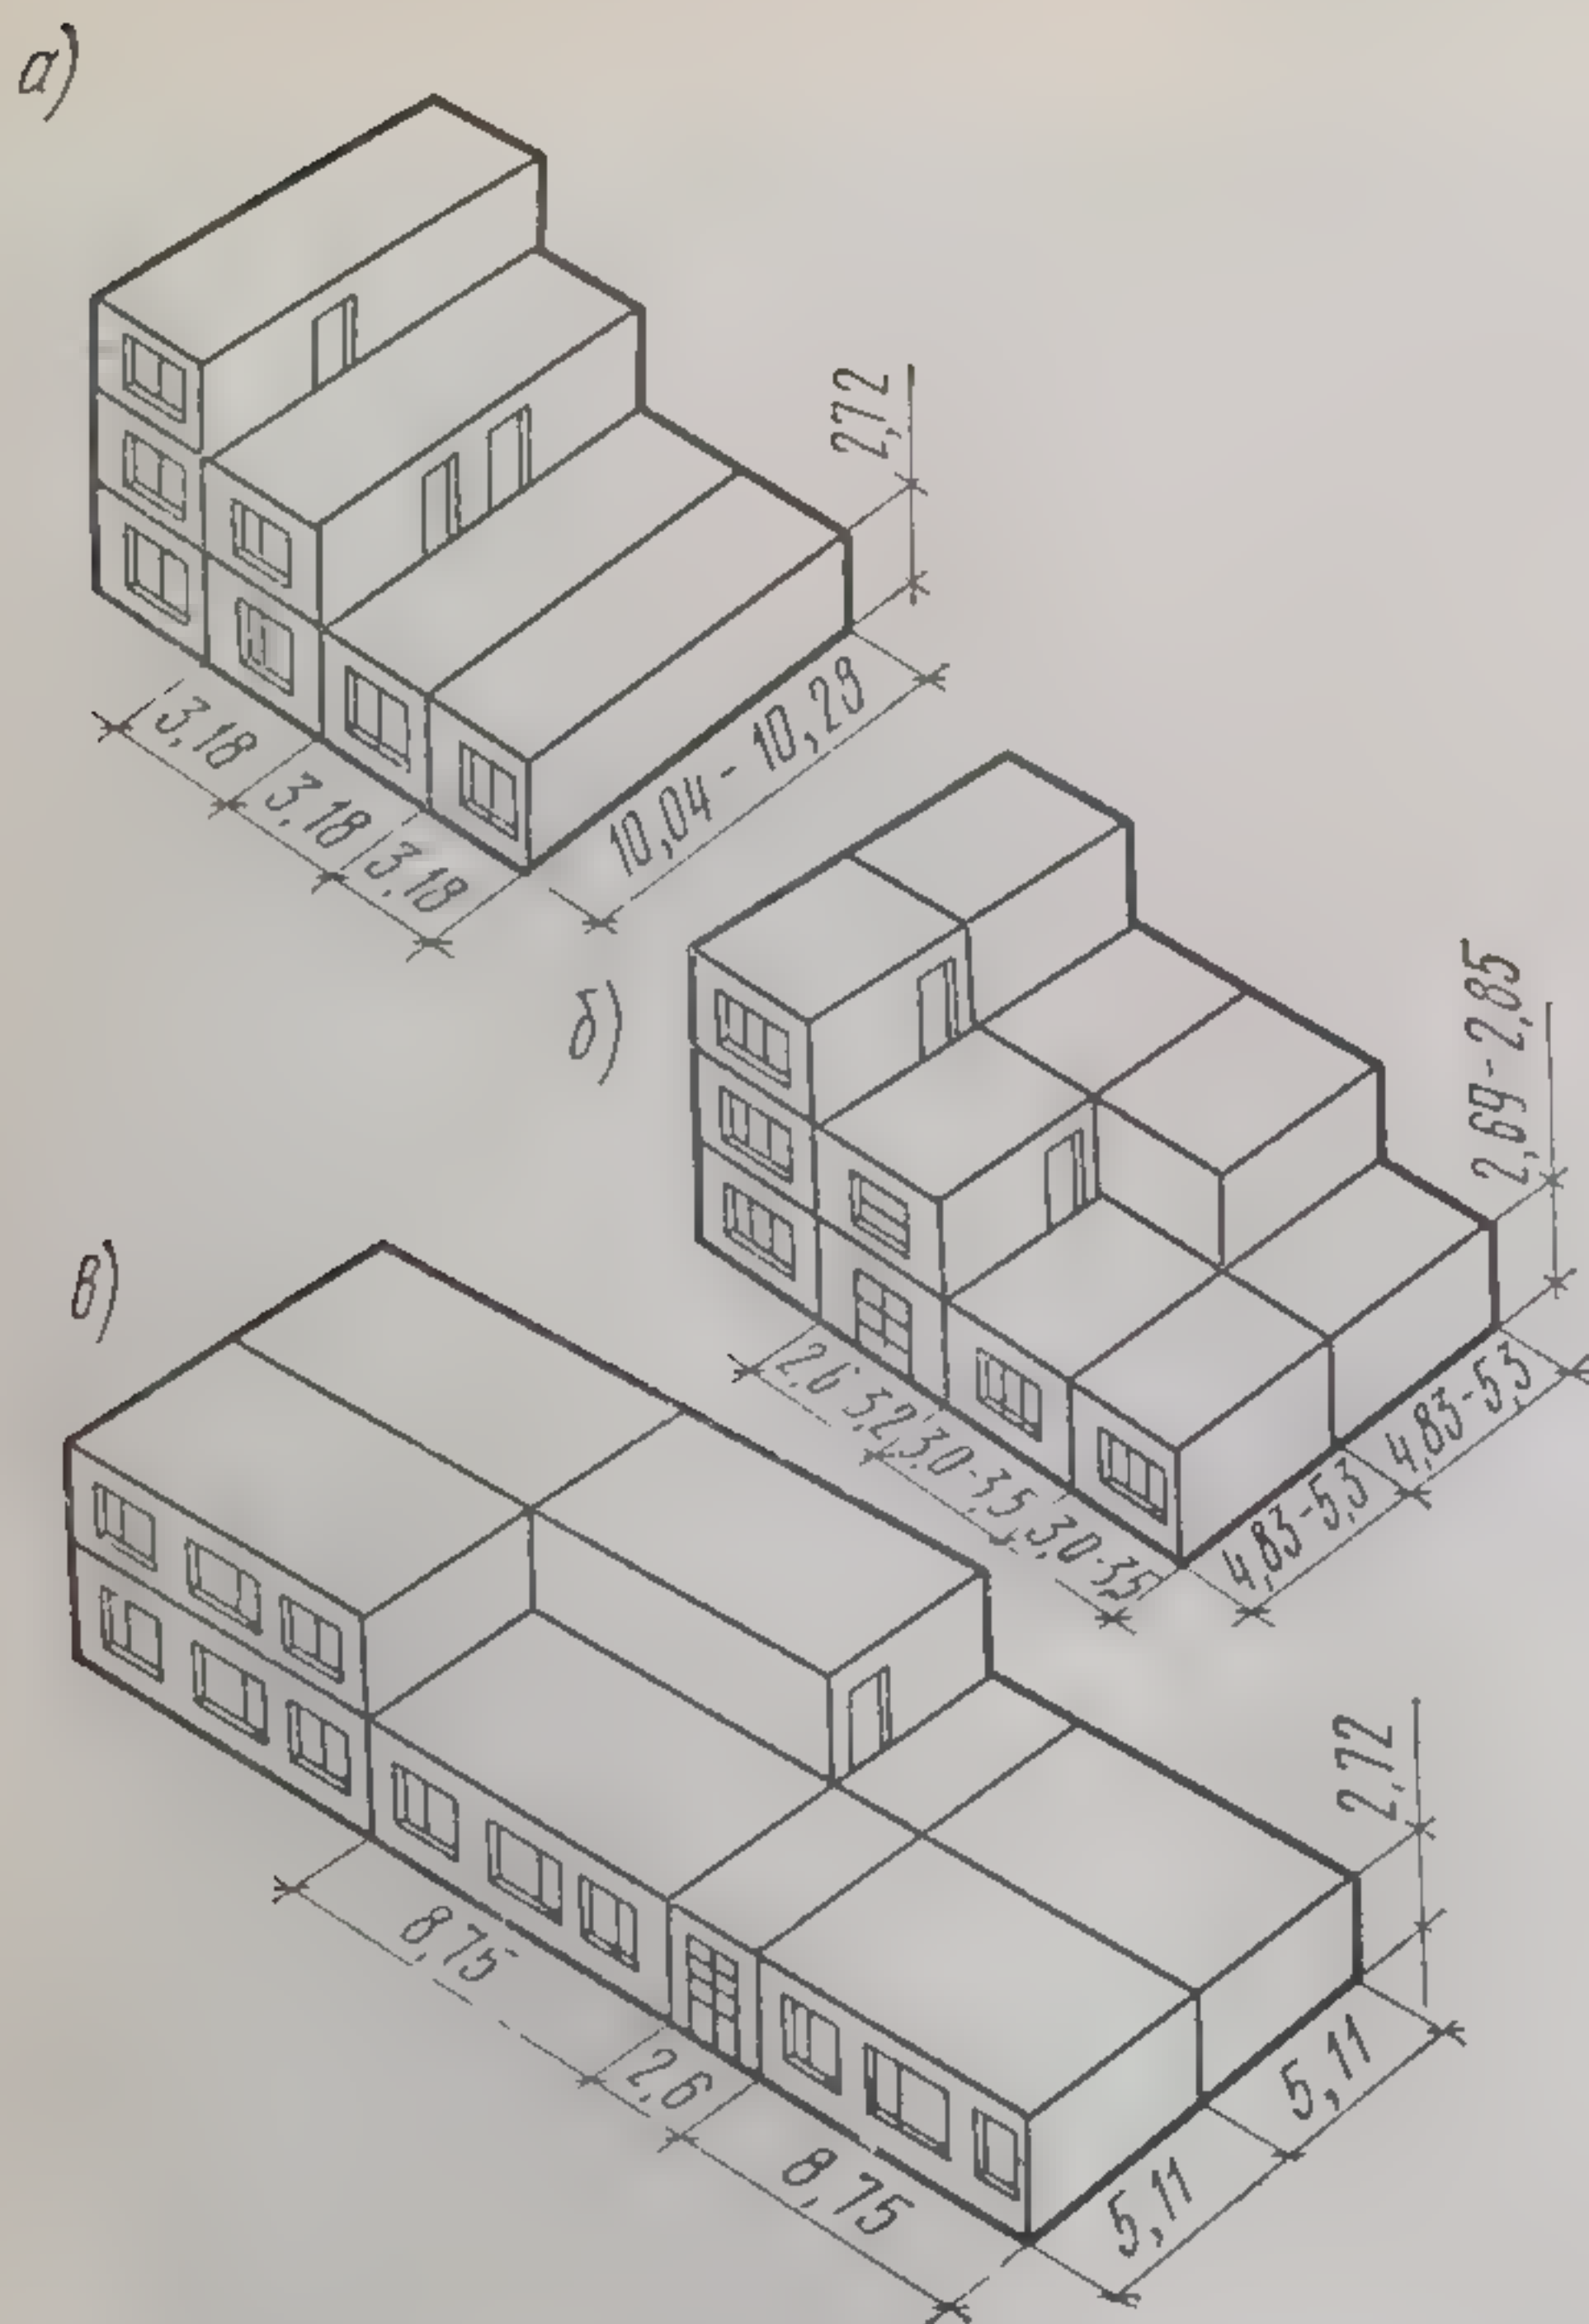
Схема зданий со сплошной расстановкой объемных элементов:
